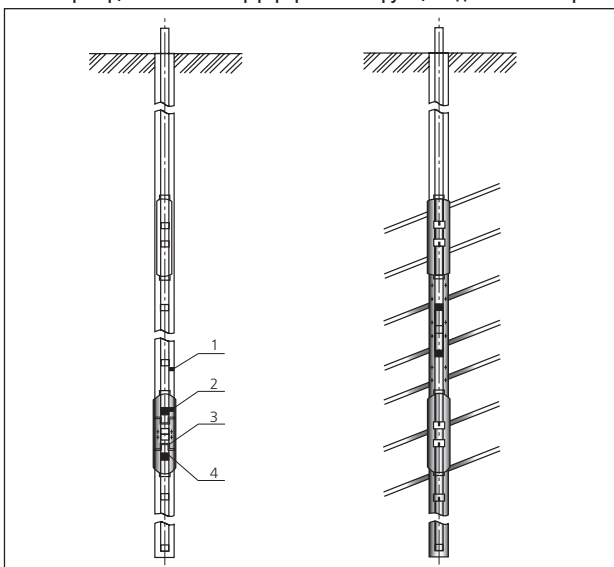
Армирование массива анкерами вокруг станции метрополитена
